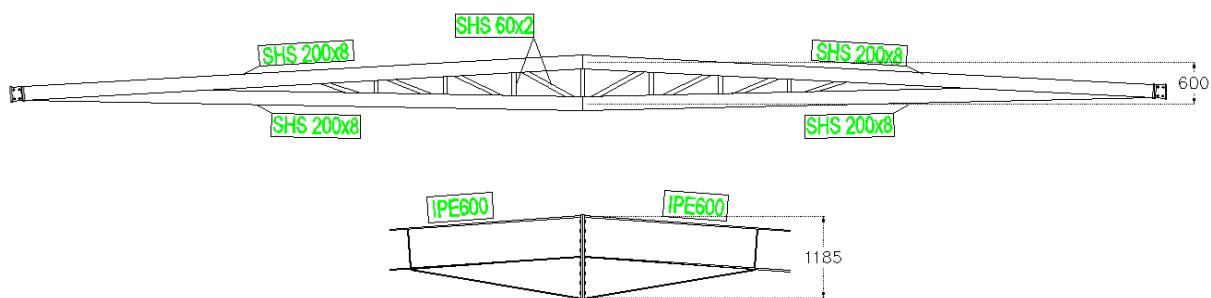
Comparação entre outra peça da viga adotada (em cima) e a ligação viga-viga (em baixo) da estrutura de perfis abertos
